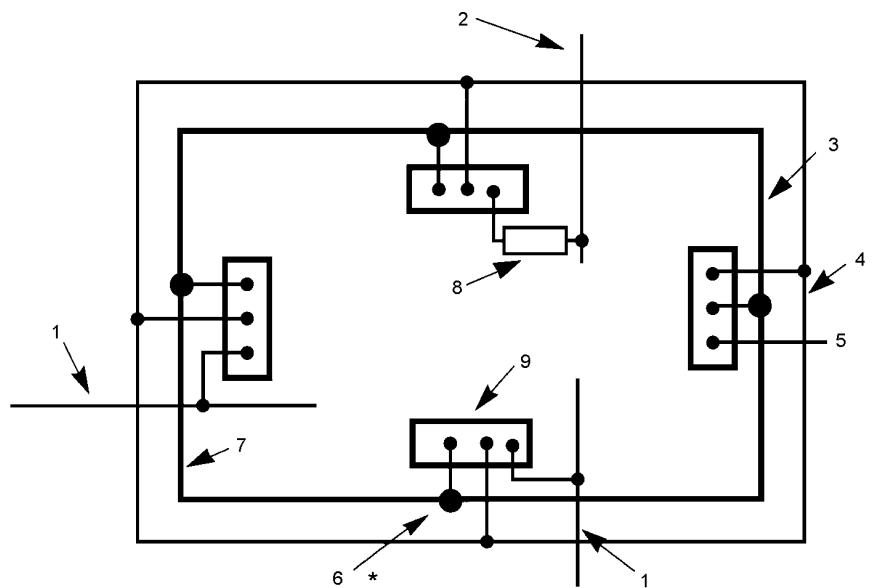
Exemple de conception d'une IPF intérieure dans une structure en béton armé
